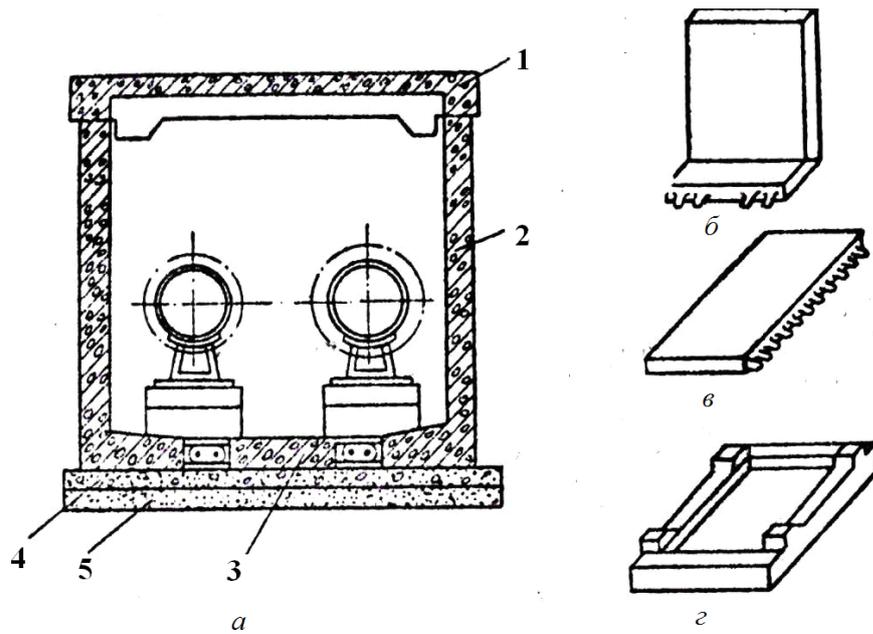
Сборный полупроходной канал из железобетонных блоков:
